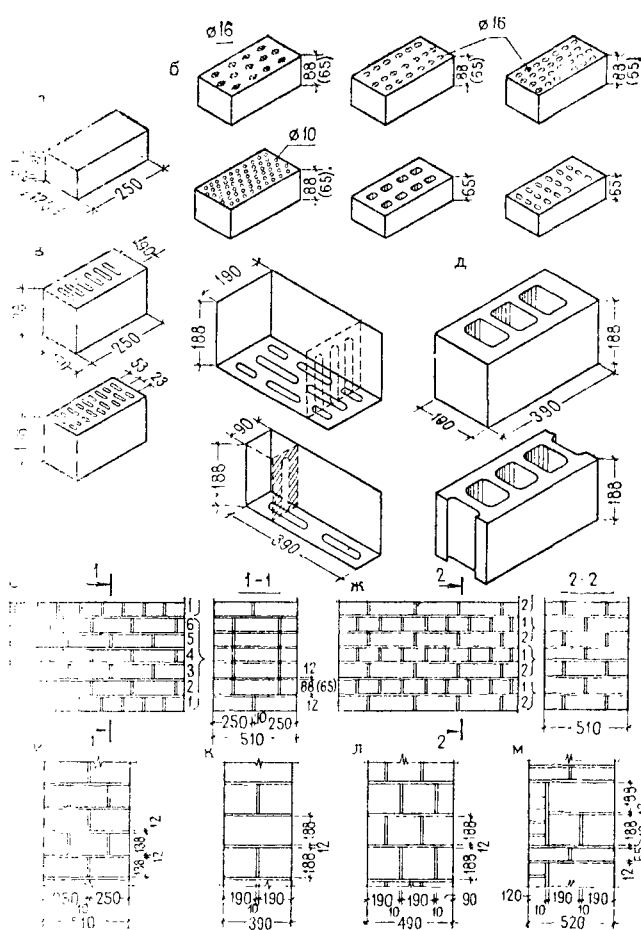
Материалы и типы сплошных кладок наружных каменных стен
